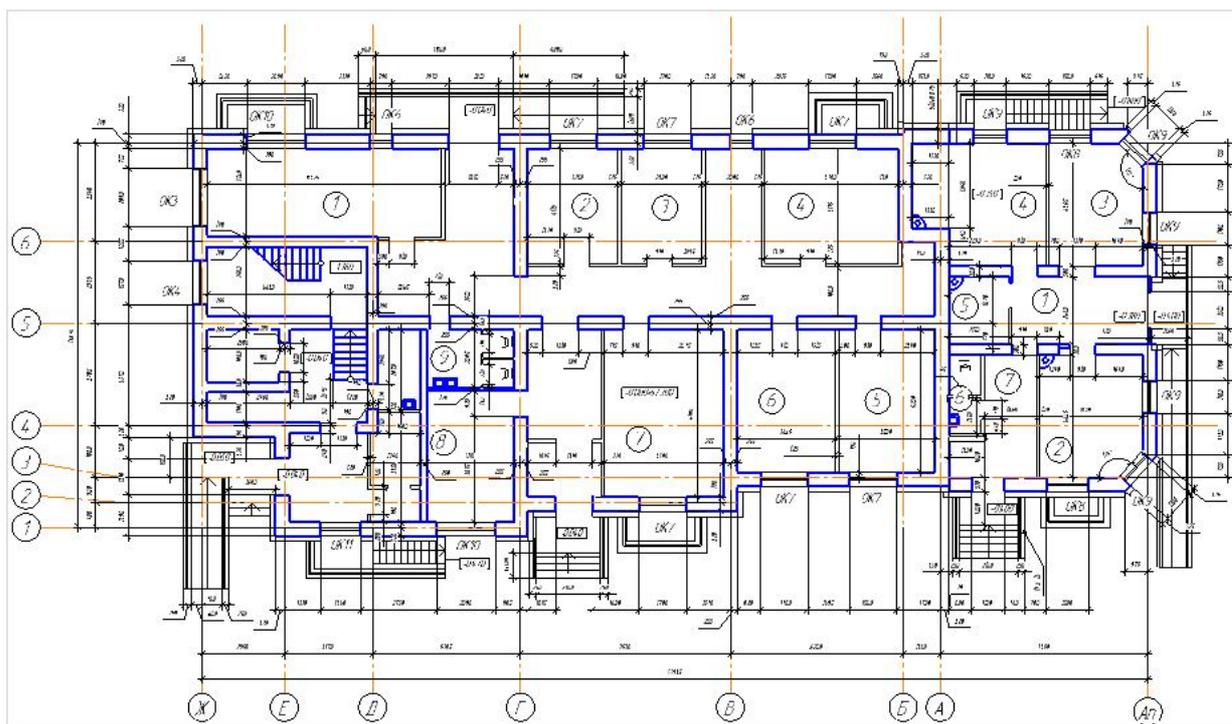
План первого этажа жилого дома после планируемой реконструкции
